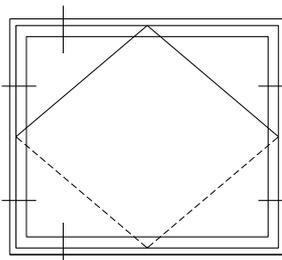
Coupe de la fenêtre à pivotement horizontal
